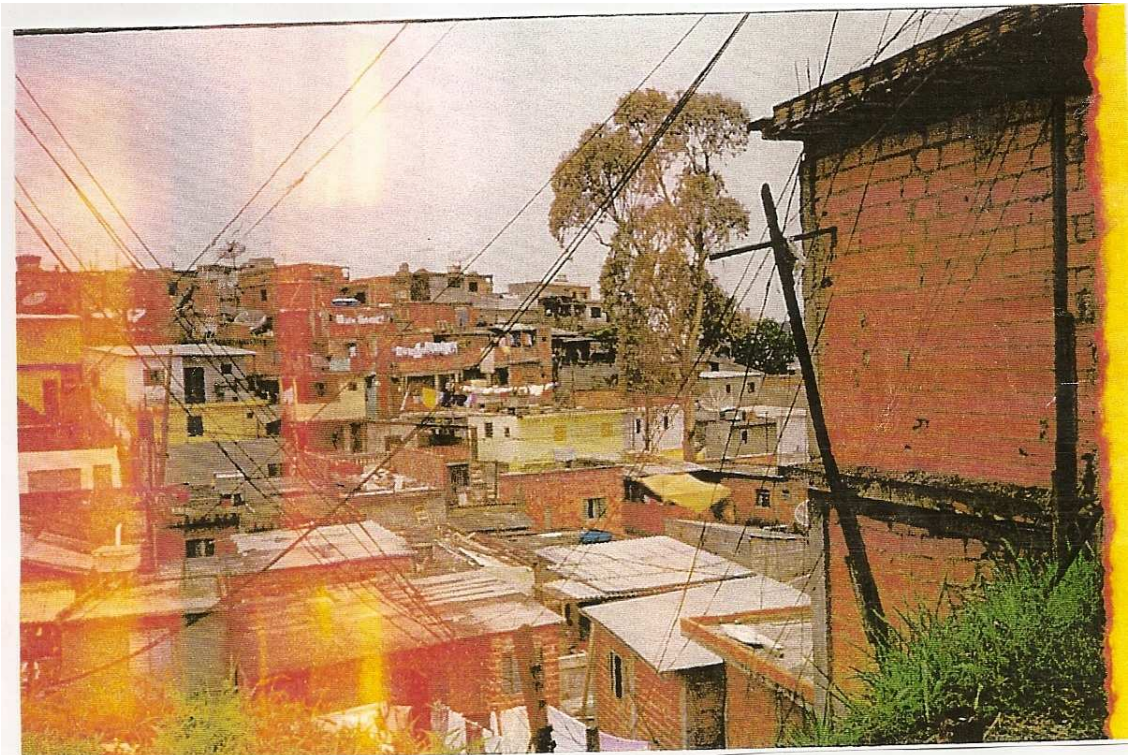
Visão das autoconstruções do bairro. Autor: Camargo (2006).
